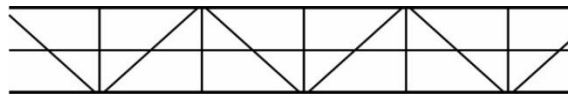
Placa de pared M. Espesor de 16 mm.
